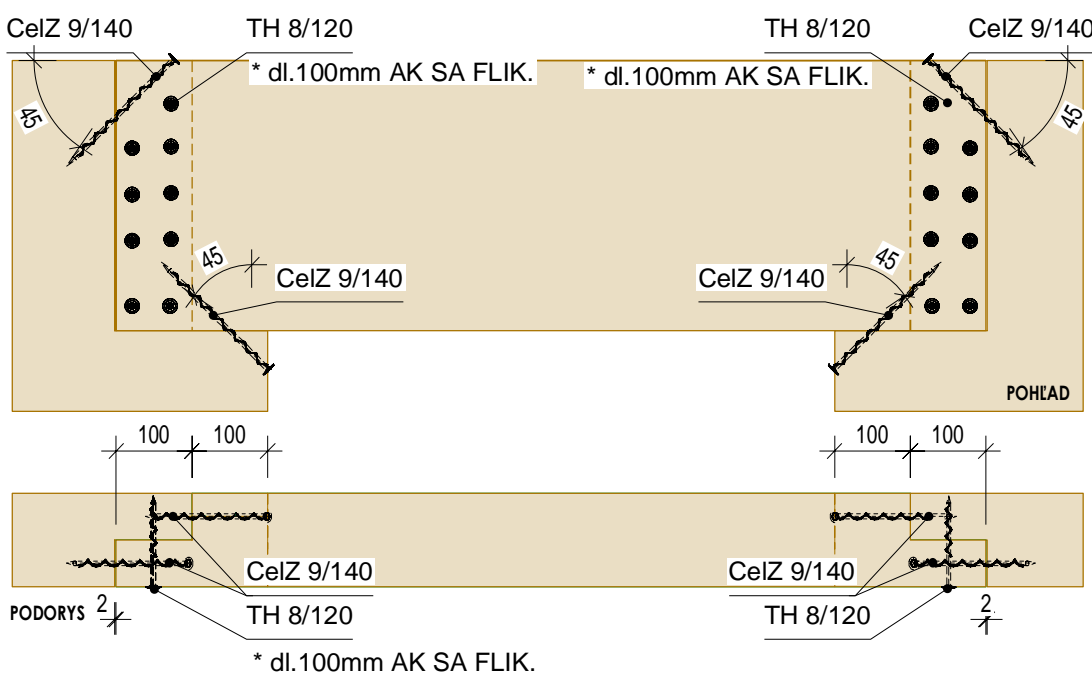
DETAIL "A" - SPOJENIE OBVODOVÝCH
